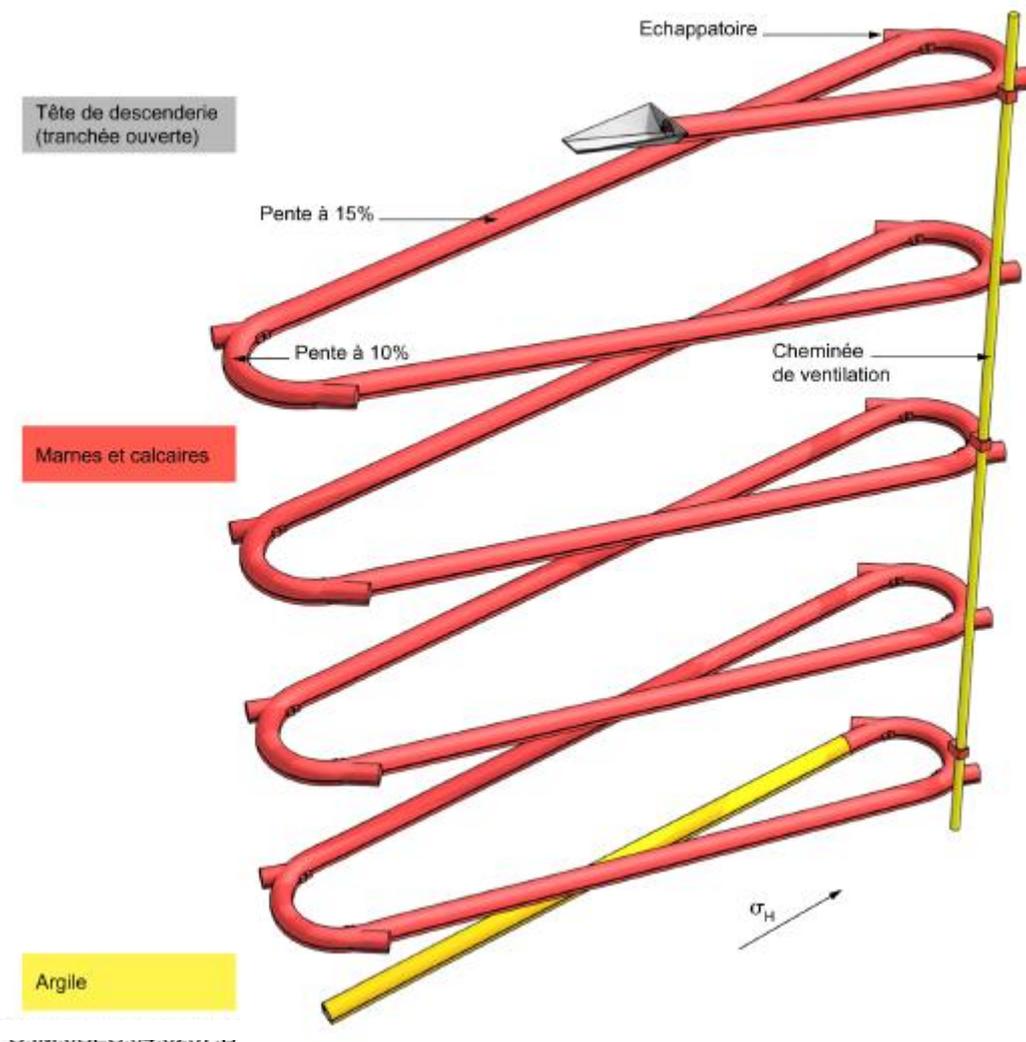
„Construction-oriented Ramp“ /AND 05/
